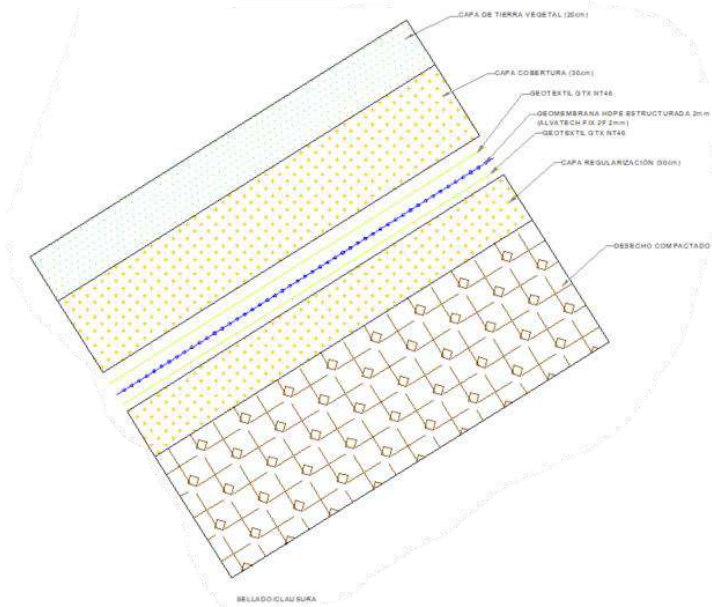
Detalle del sistema de impermeabilización sellado/clausura
